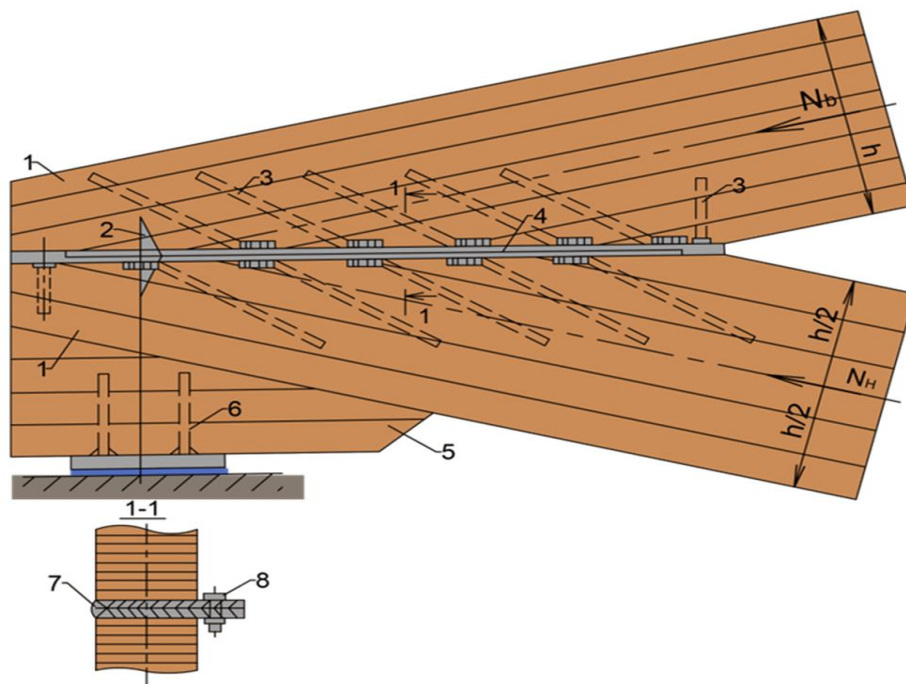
Схема опорного узла линзообразной фермы
